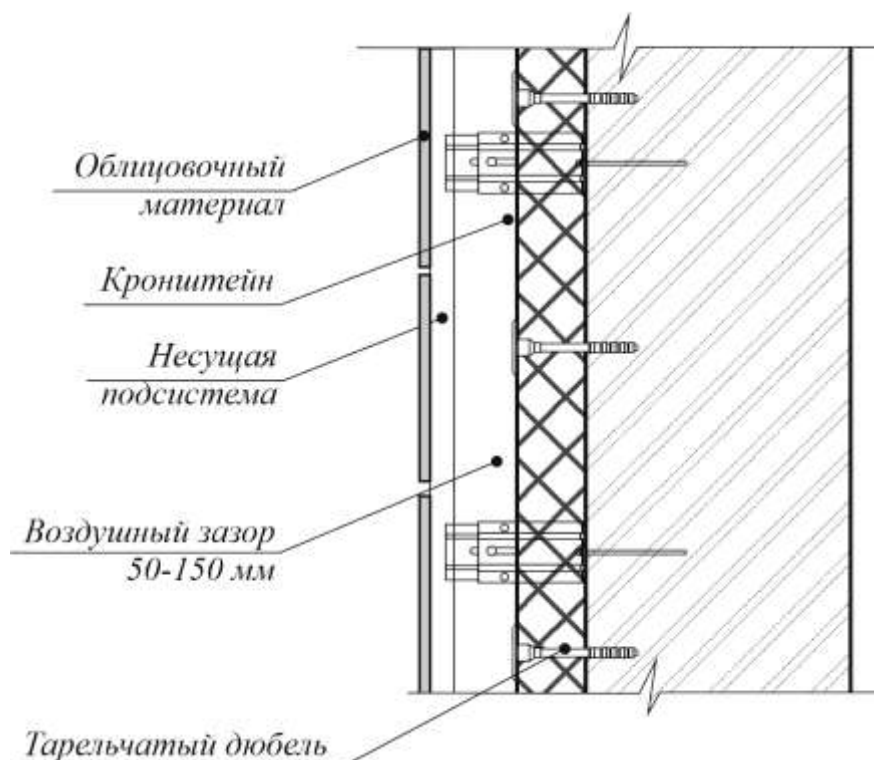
Сечение наружной стены с системой навесного фасада
